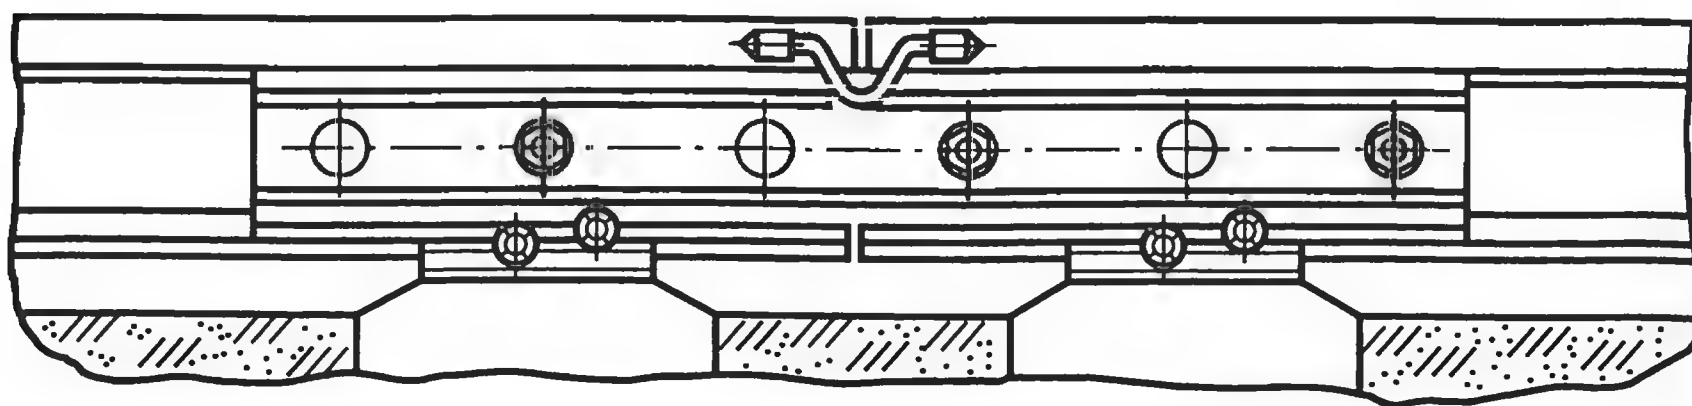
Место установки рельсовых стыковых приварных соединителей
